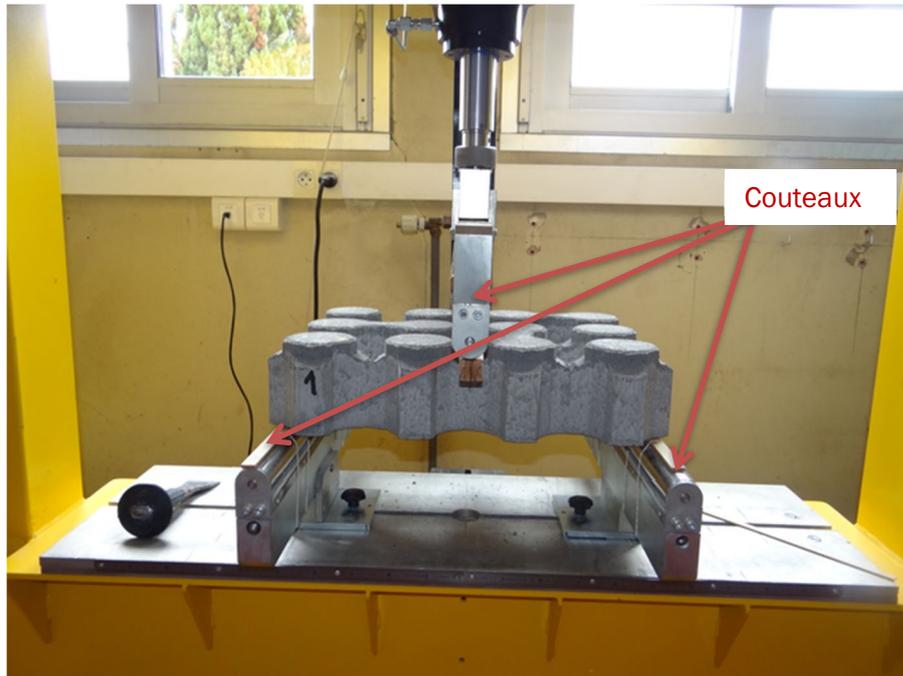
Essai de flexion 3 points sur dalle drainante engazonnée ou gravillonnée
